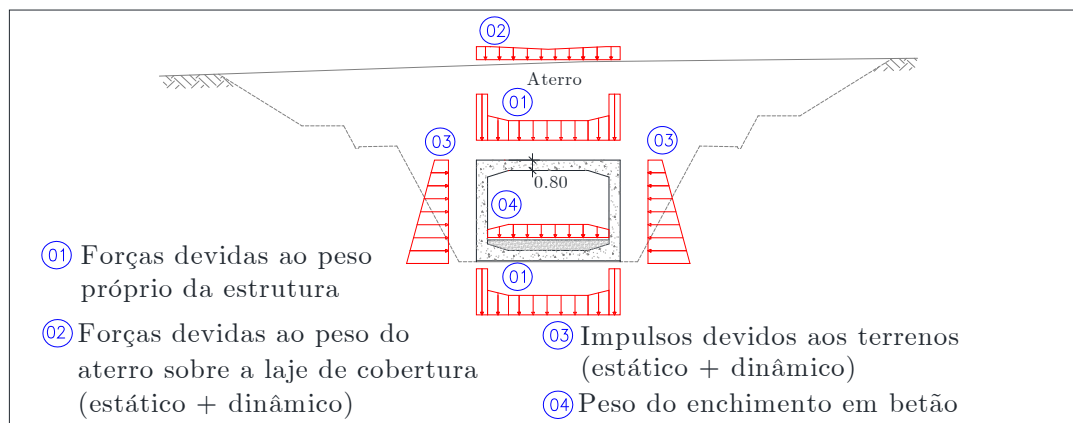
Caso de Carga 2 – Secção com laje de 0.80 situada entre taludes de escavação.
